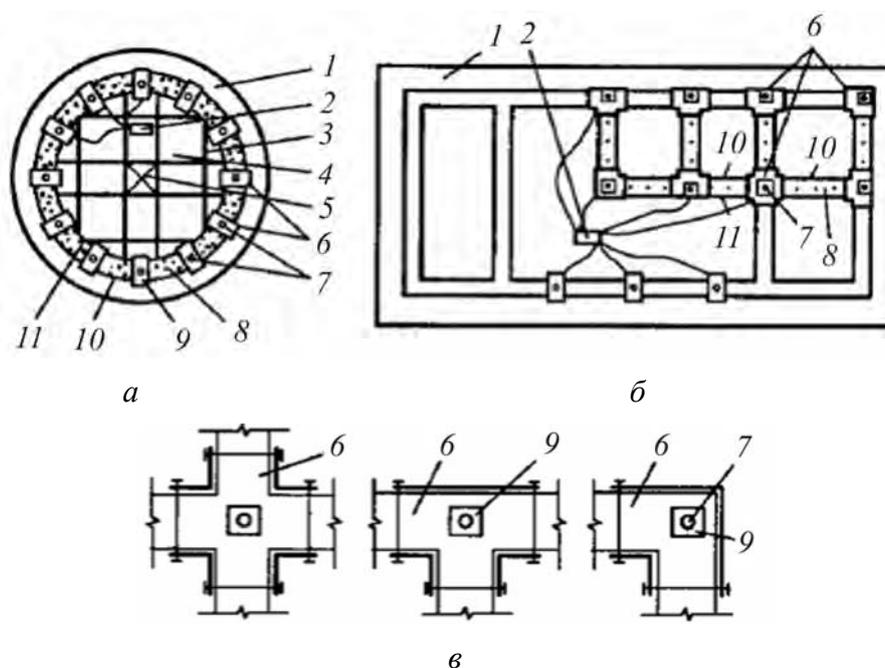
Скользящая опалубка: *а* — план для круглого сооружения; *б* — то же, для прямоугольного; *в* — варианты домкратных рам (для узла пересечения стен, примыкания и угла здания); 1 — рабочий настил; 2 — насосная станция; 3 — прогон; 4 — настил; 5 — шахтный подъемник; 6 — домкратные рамы; 7 — домкратные стержни; 8 — бетонизируемая конструкция; 9 — домкраты; 10 и 11 — наружный и внутренний щиты опалубки [24]
